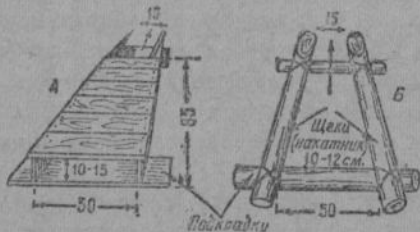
Заготовка стрелковых бойниц из лесного материала.
